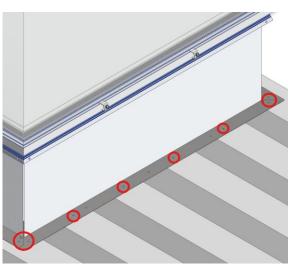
WiNa Stairvent met opstandhoogte 360 rechtstreeks op steeldeck (JID 137)
